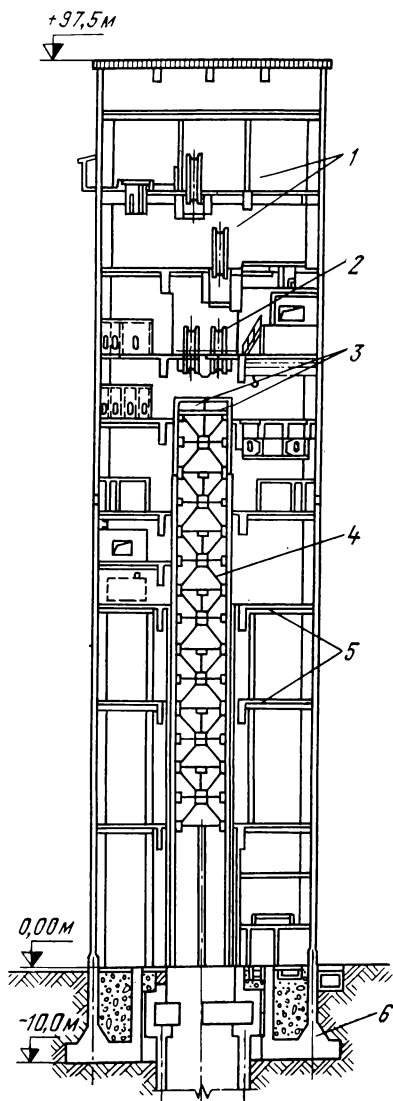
Вертикальный разрез железобетонного башенного копра:
